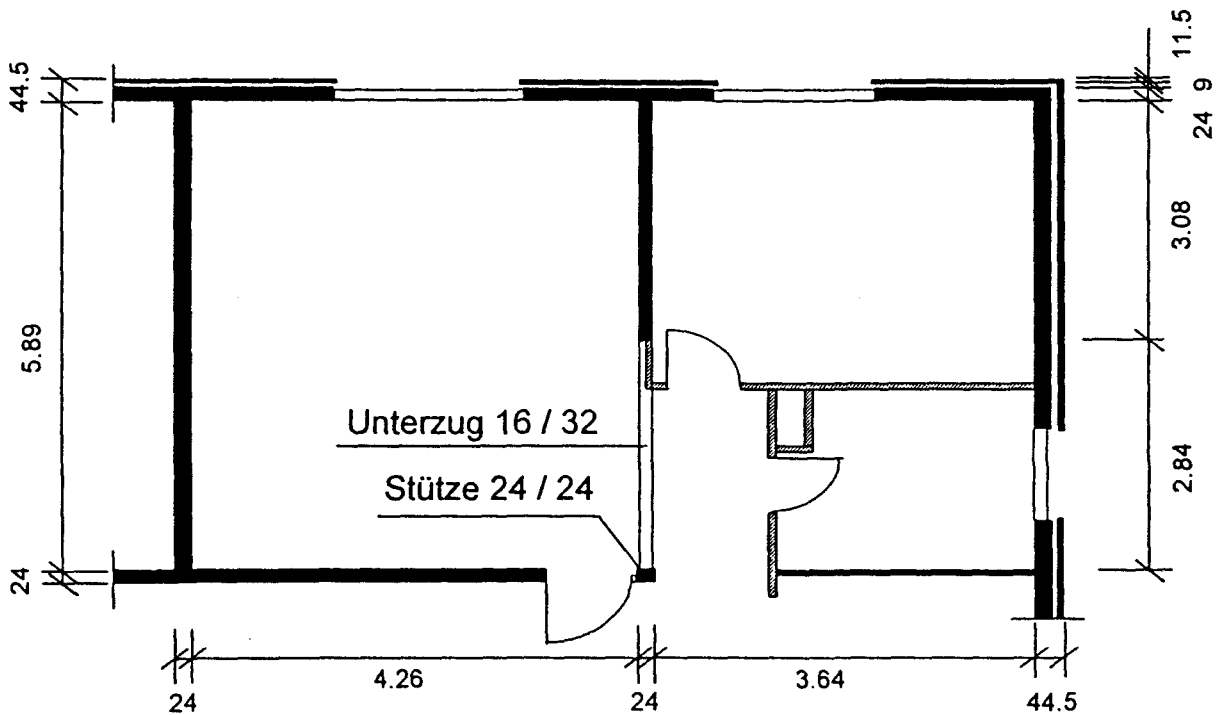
Wohnhaus: Grundriß im Erdgeschoß
